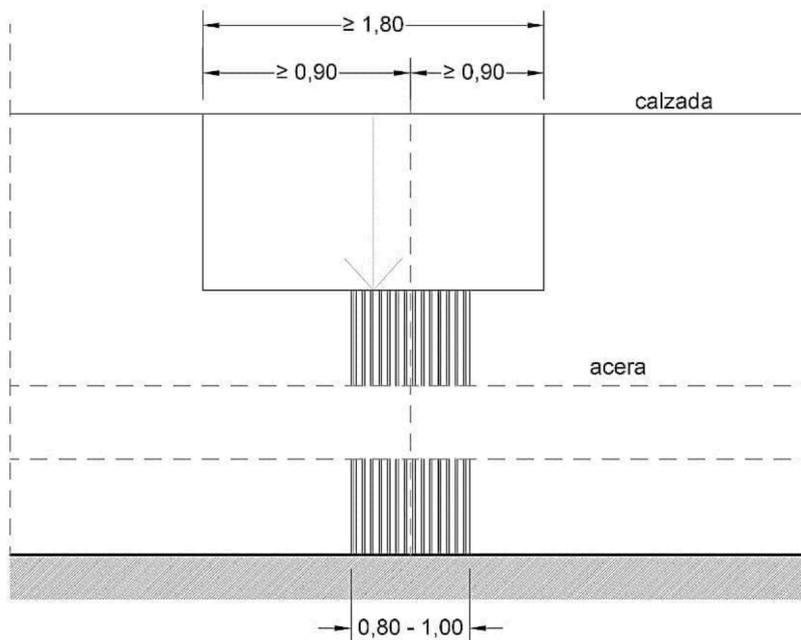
8. Franja de encaminamiento descentrada en vados de anchura superior a 1,80 m
